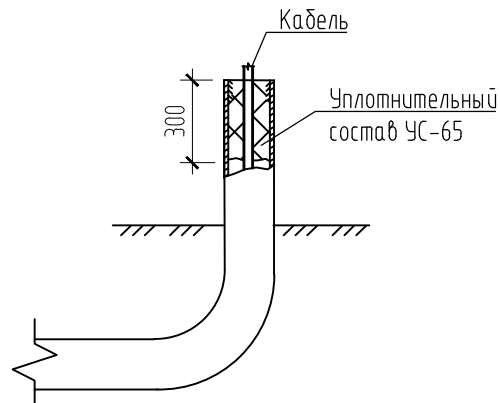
Заделка концов водогазопроводных труб после прокладки кабеля
